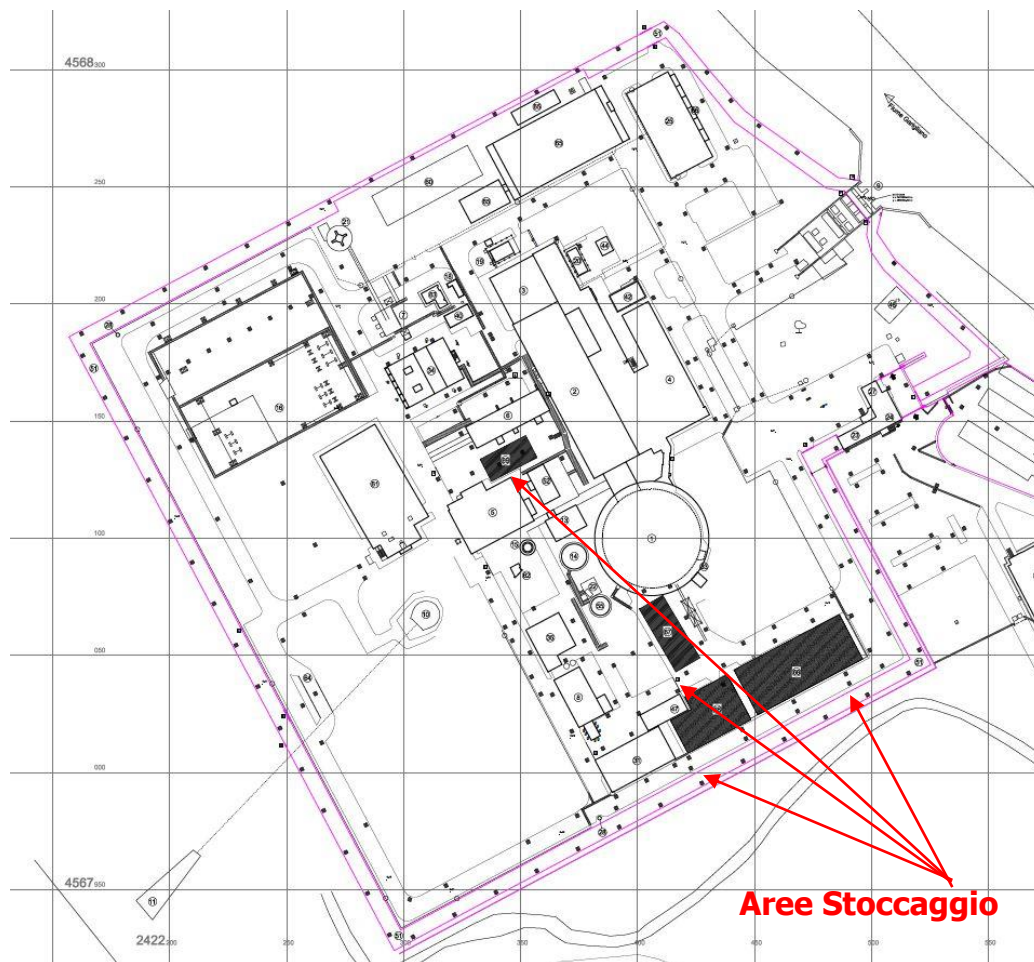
Planimetria Aree di stoccaggio (estratto da GRST00134)
